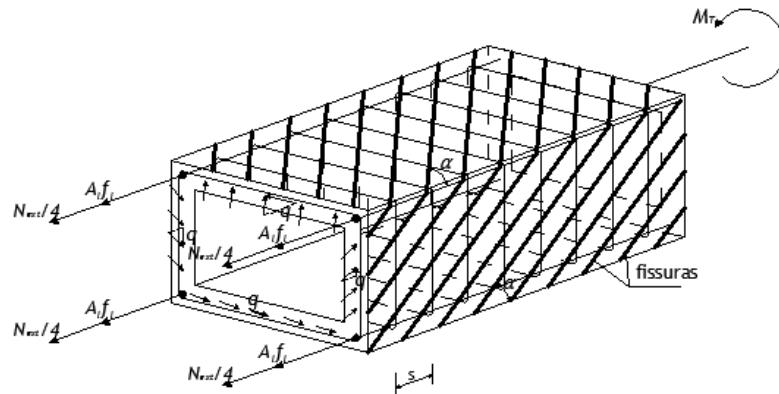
Equilíbrio longitudinal de uma viga de secção retangular vazada
